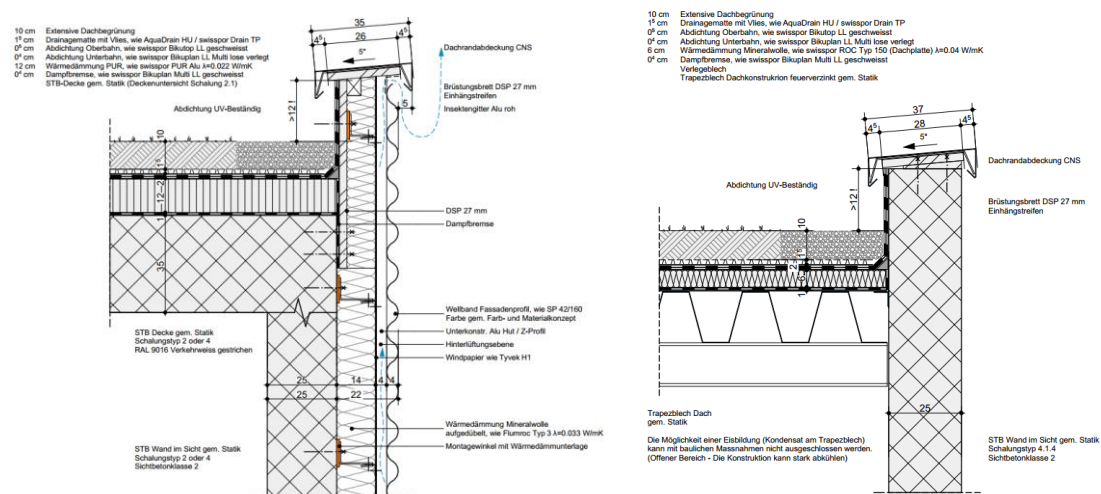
Dachranddetail Kopfbau (l.), Filtration (r.)
